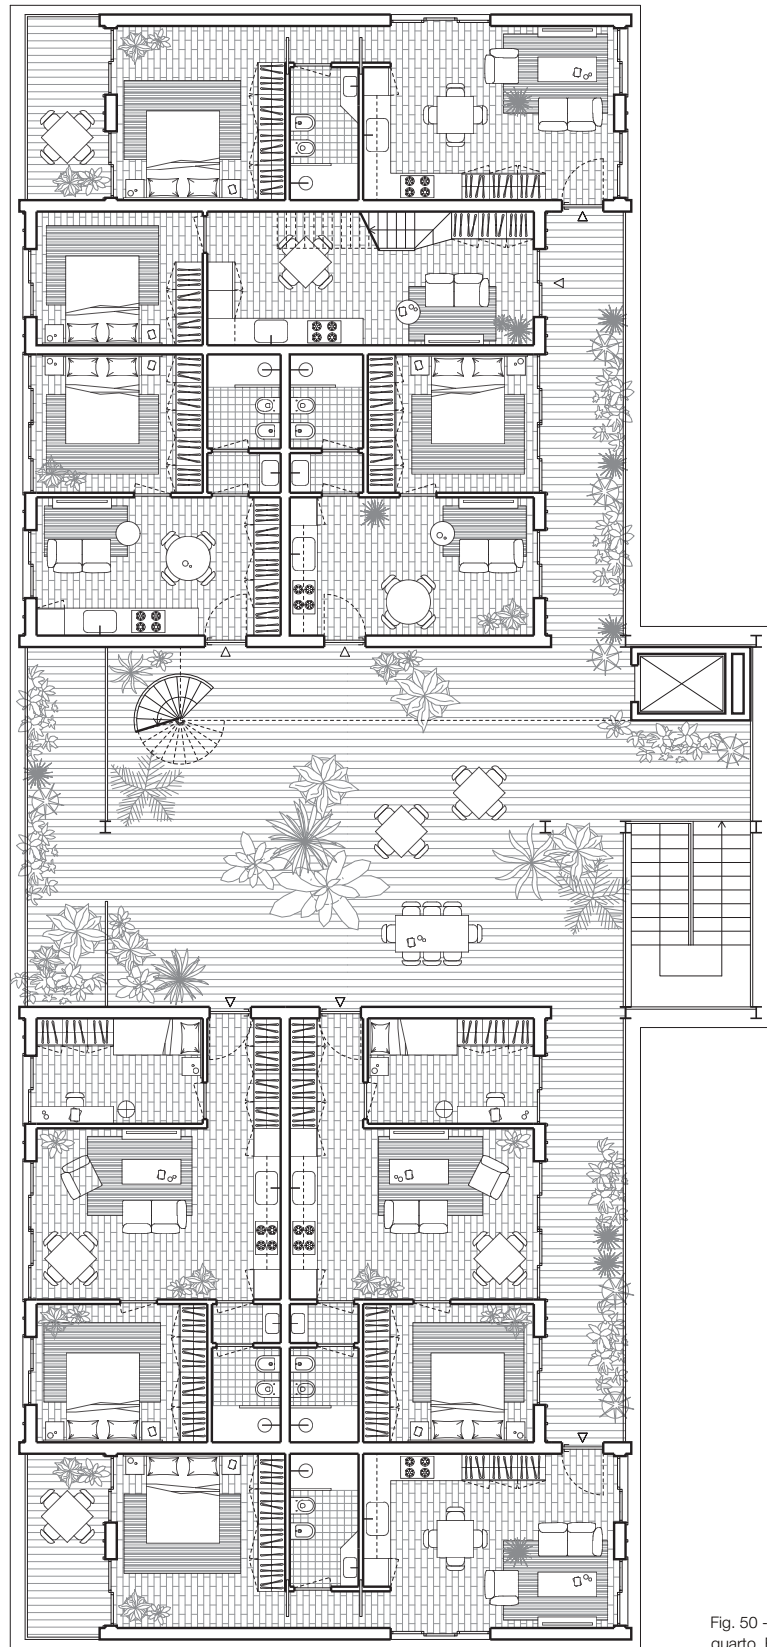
Pianta di progetto piano quarto. Elaborazione degli autori.
